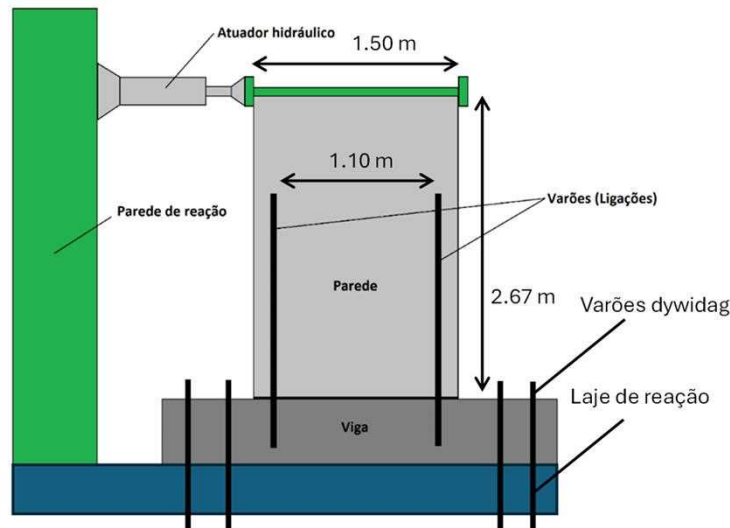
Dimensão geométrica do provete e *setup* experimental.
